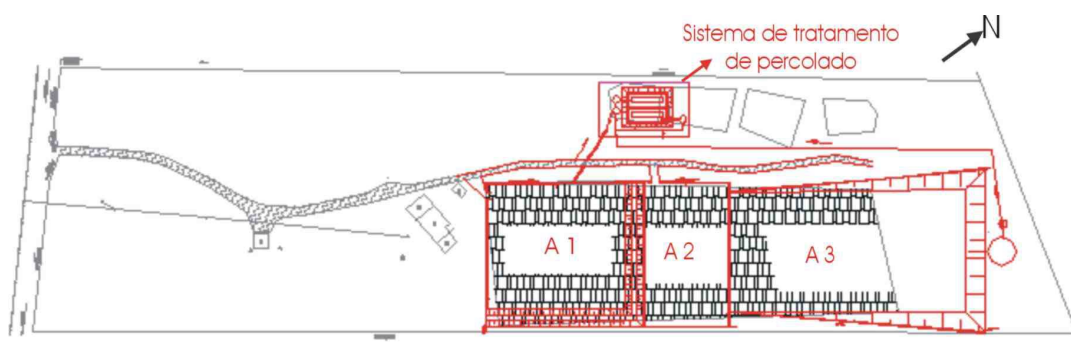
Planta baixa esquemática com o arranjo geral dos projetos de adequação ambiental do Lixão de Santiago.
